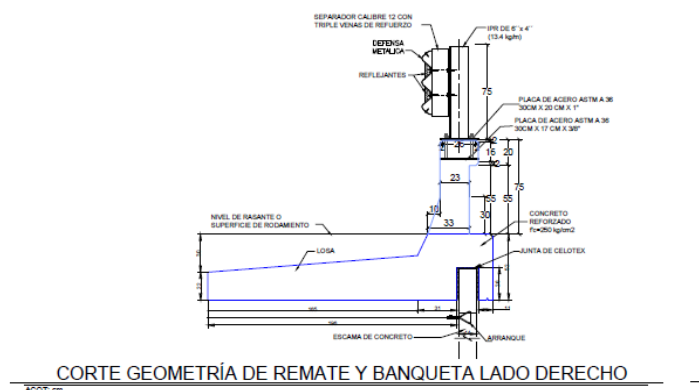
NOTA: Adaptado de Plano de Remate con Guarnicion, Autoría Propia, 2023
